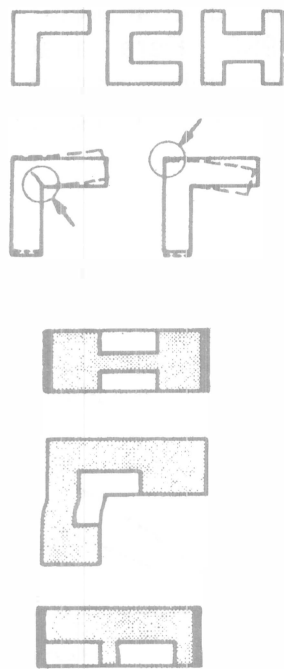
Plantas irregulares en edificios de mampostería (Paulay y Priestley, 1992)
